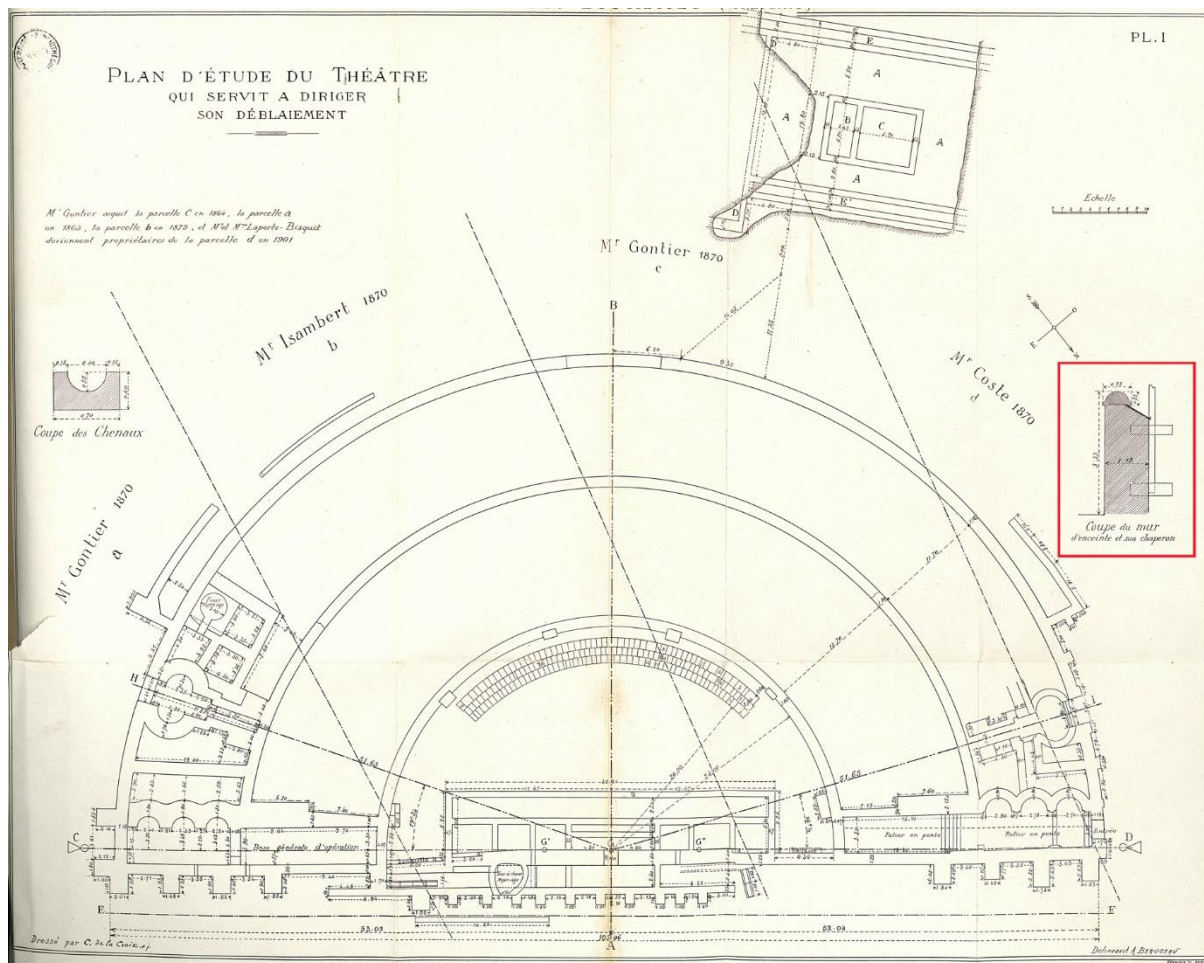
Plan au sol du théâtre de Saint-Cybardeaux
